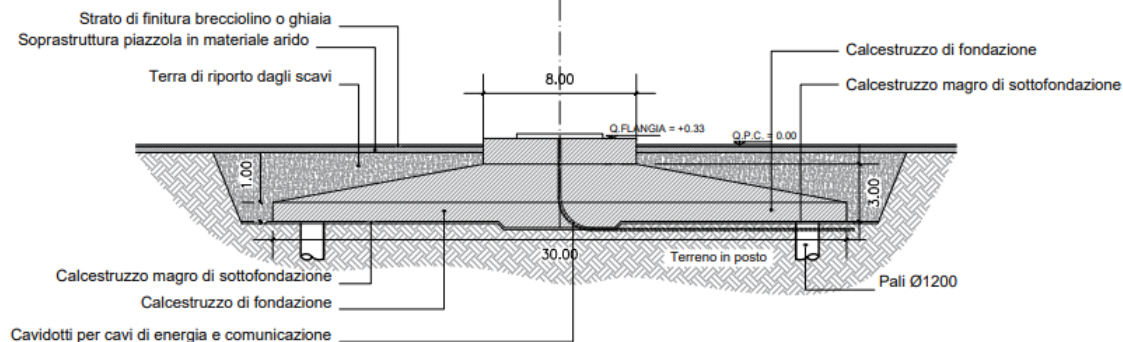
Dettaglio sezione basamento di fondazione in progetto torre tipologia V162
